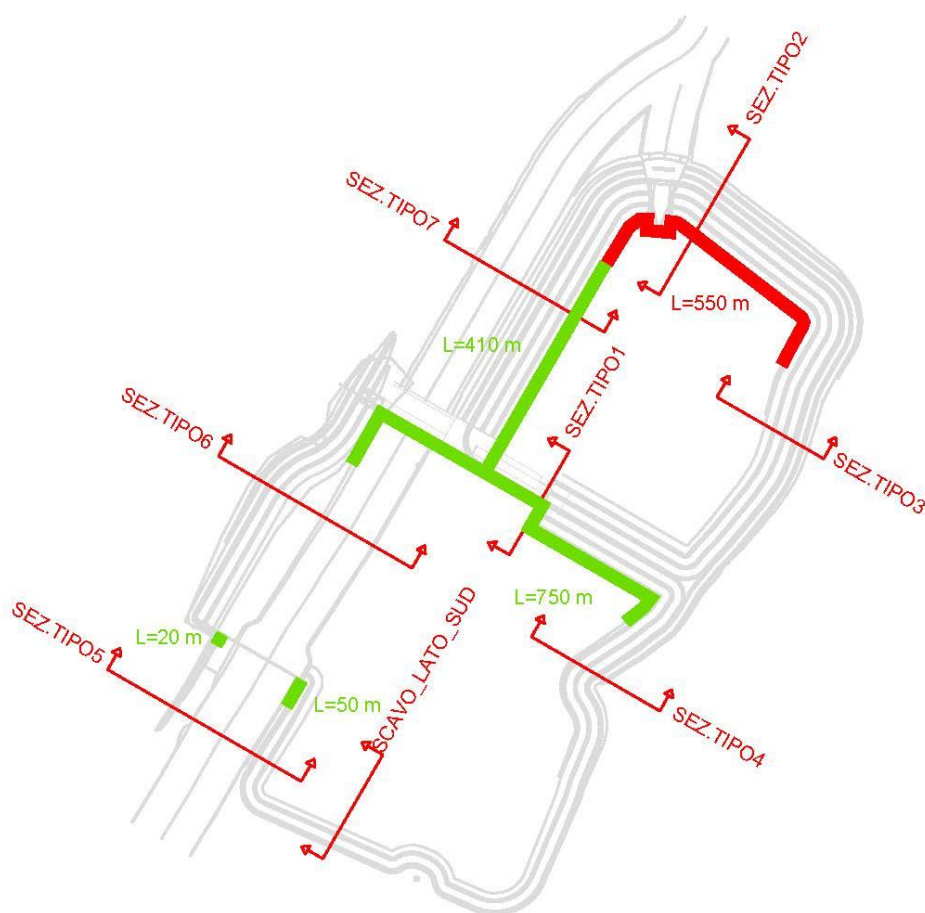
Planimetria con ubicazione dei diaframmi di tenuta
